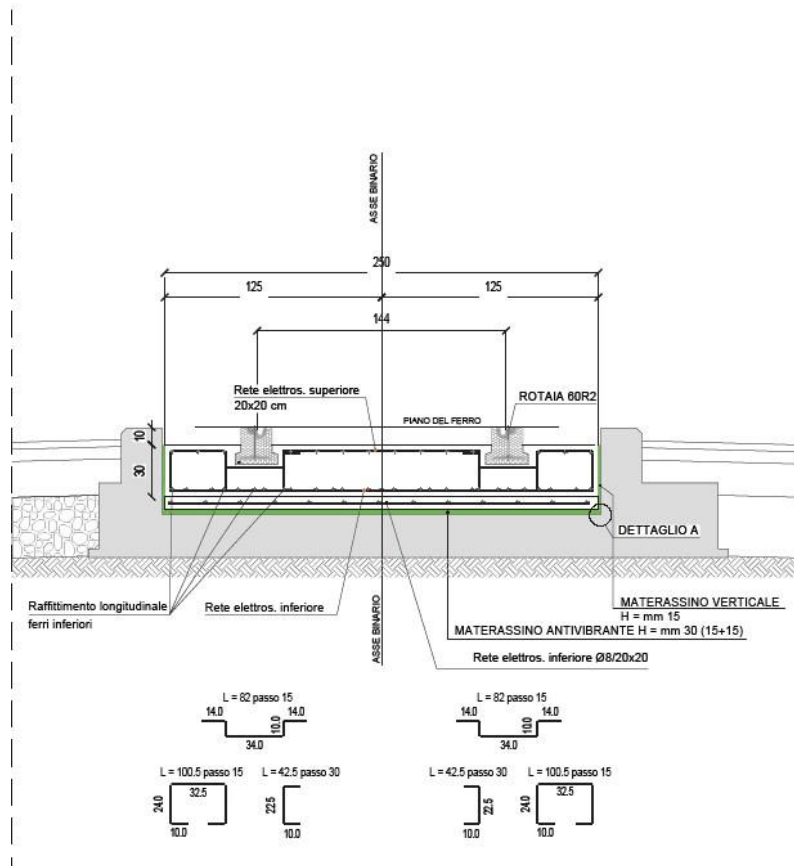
Esempio tipologia armatura delle solette di armamento L2
